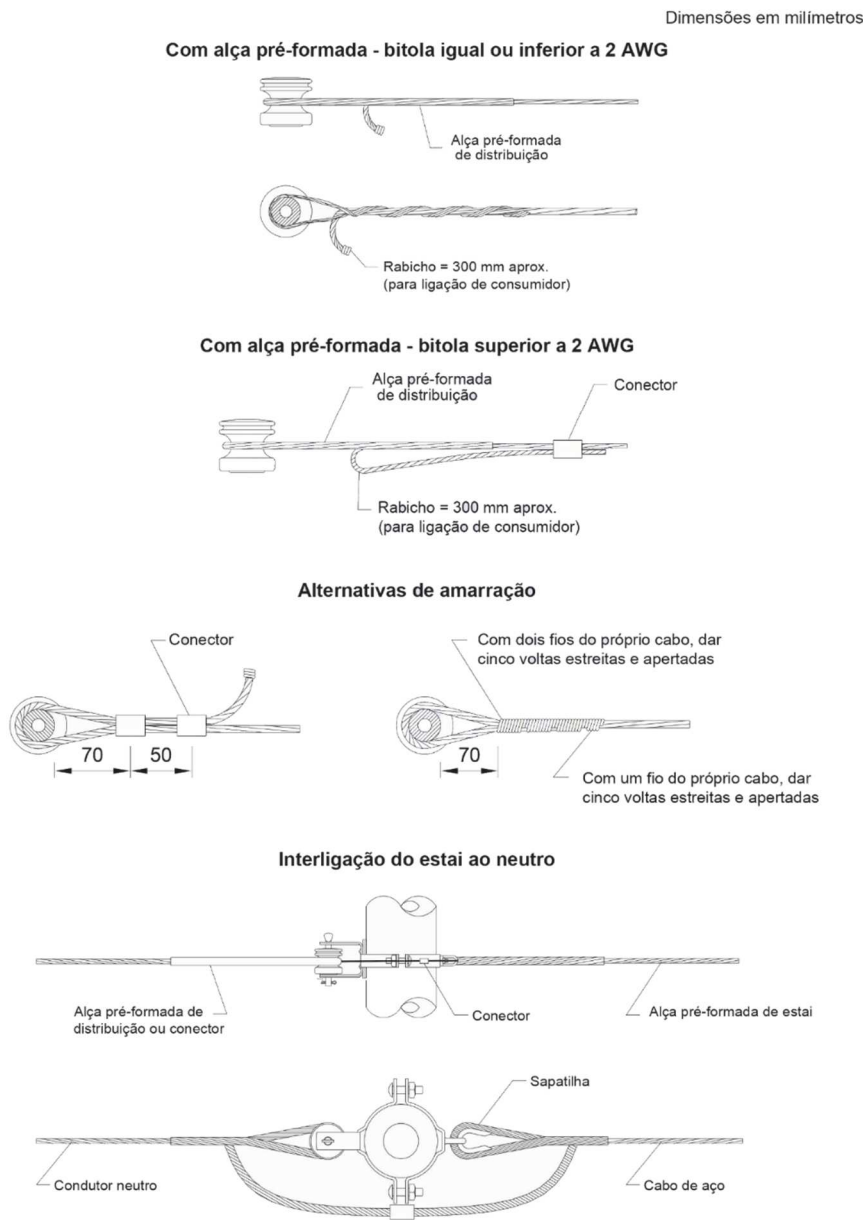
Amarrações e ligações – Secundário – Fim da linha
